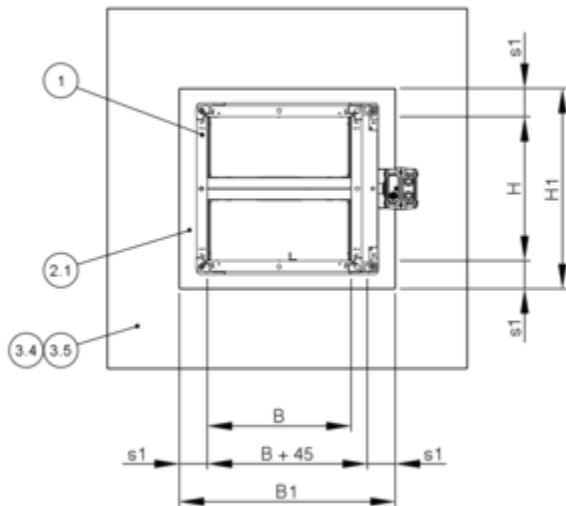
Leichtbauwände mit Holzständerwerk/Holzfachwerk – Anordnung/Abstände
